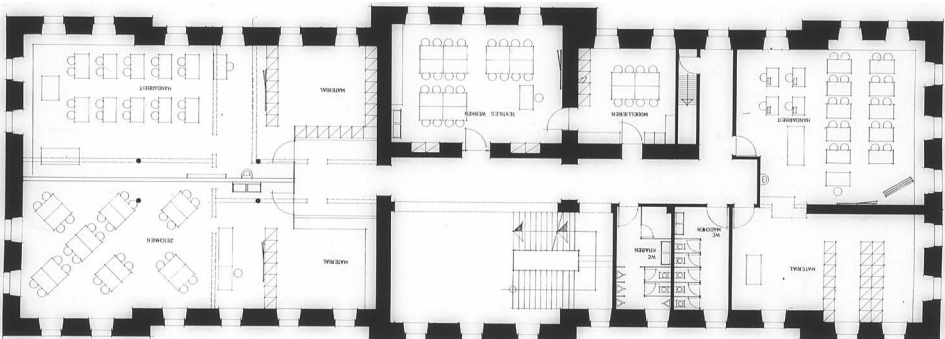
Propstei in Klingnau, Grundriss des 3. OG
